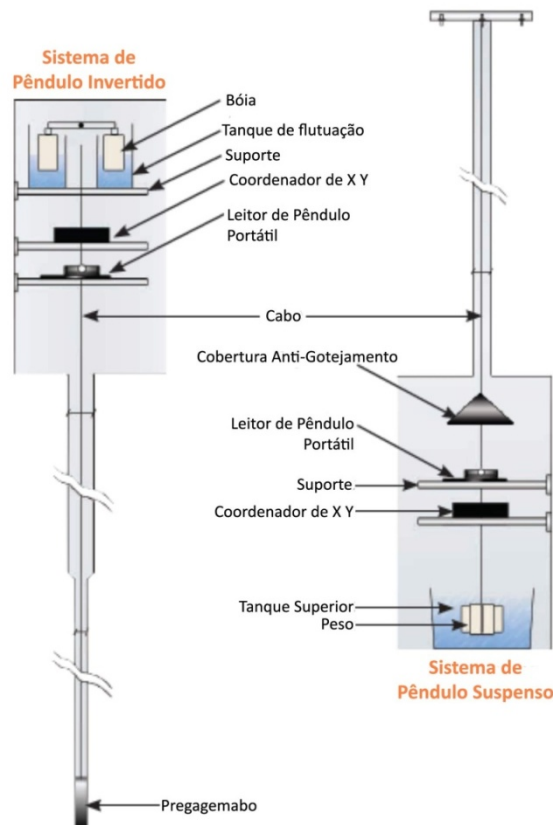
Sistema de pêndulo invertido e pêndulo suspenso (adaptado de Soil Instruments 2010).
